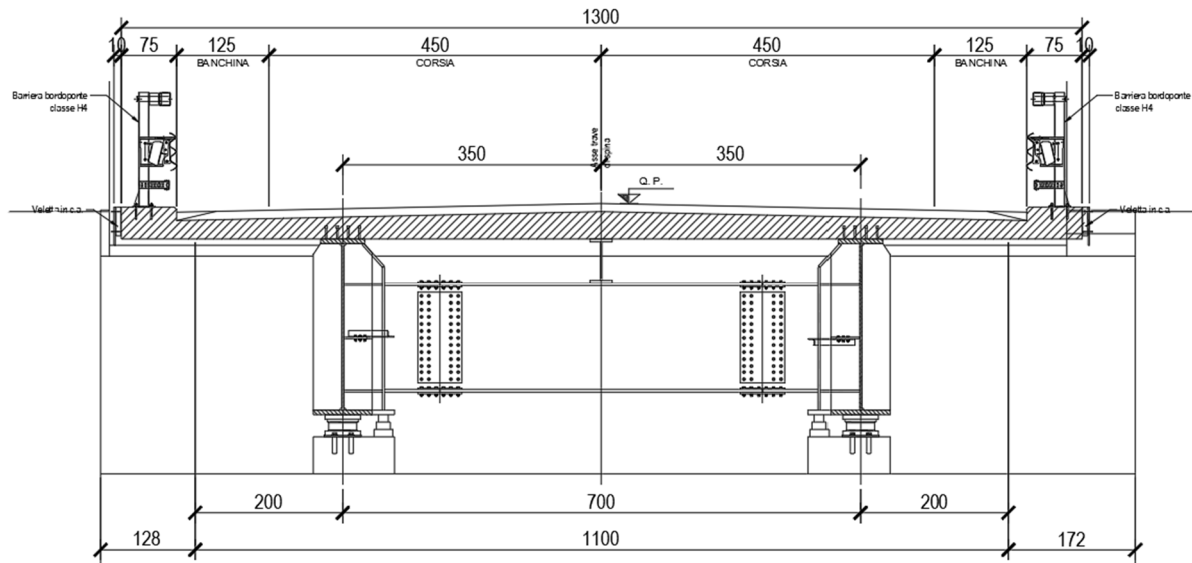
Sezione trasversale dell'impalcato su asse appoggi
